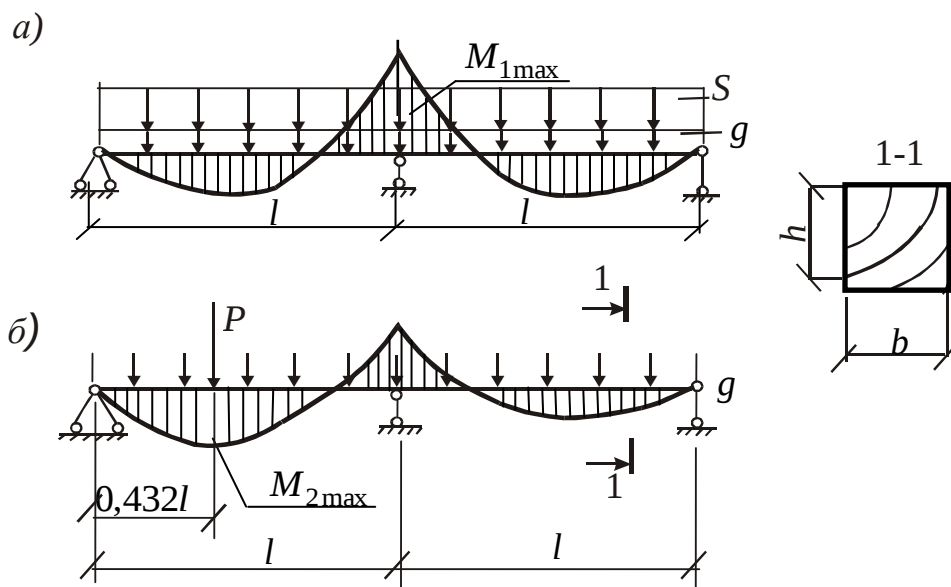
Расчетные схемы настила и обрешетки: а – при первом сочетании нагрузок;
